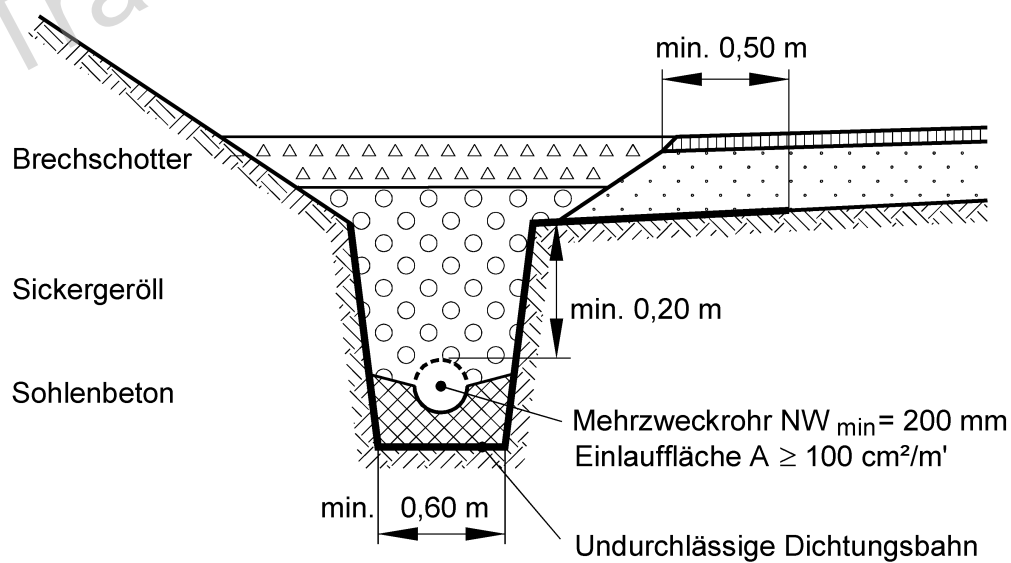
A811 : Drainage de type 4b, dérivation avec étanchéité de la tranchée (nouvelle construction).
